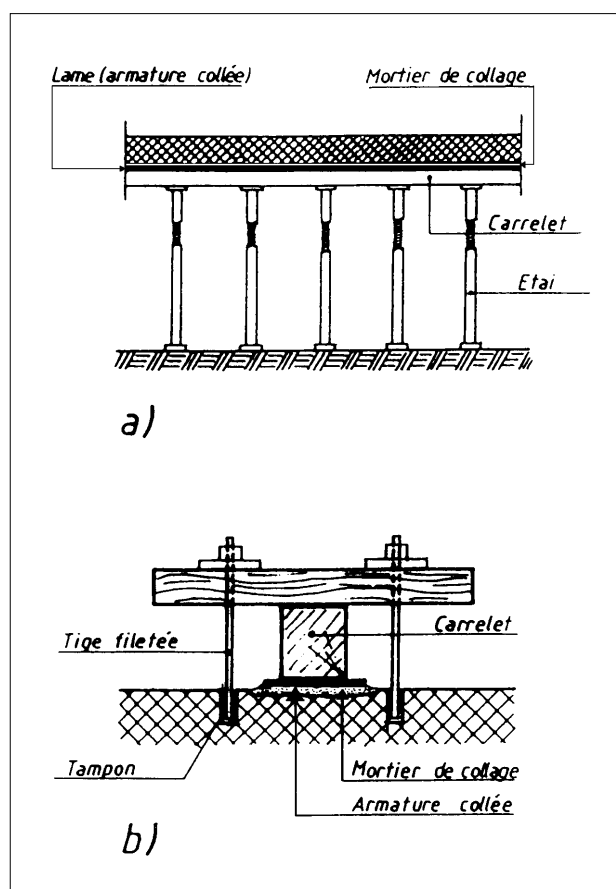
Exemples de dispositifs d'application de la pression de serrage.
